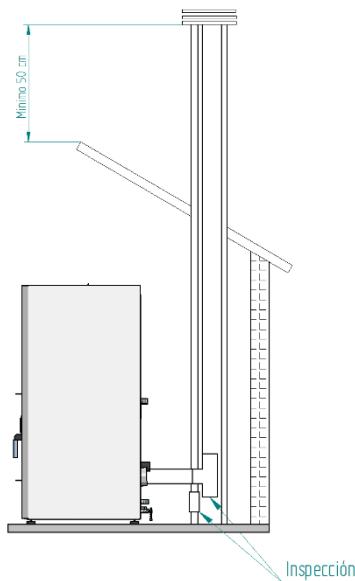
Vista lateral de la instalación con chimenea, con ejemplo del punto de inspección.
